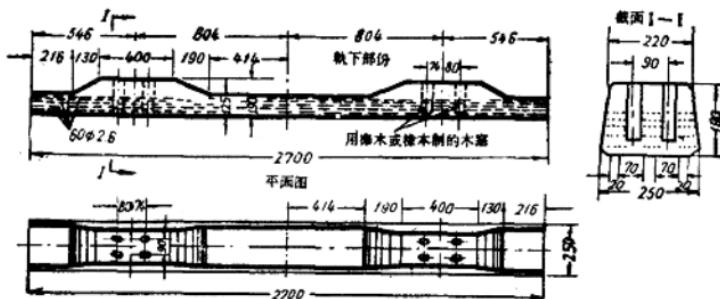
苏联O—55型整体先张钢弦钢筋混凝土轨枕
